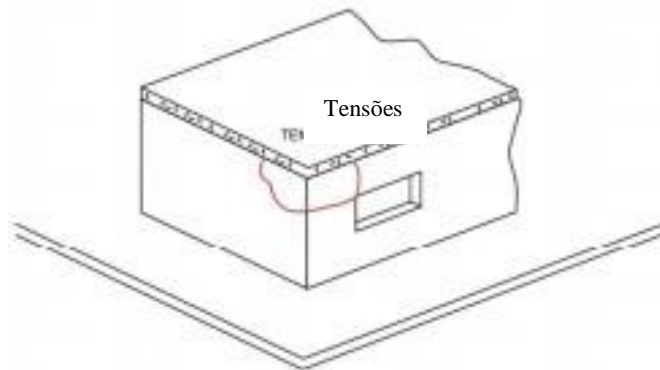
Fissura ocasionada por movimentação térmica da laje de cobertura.
